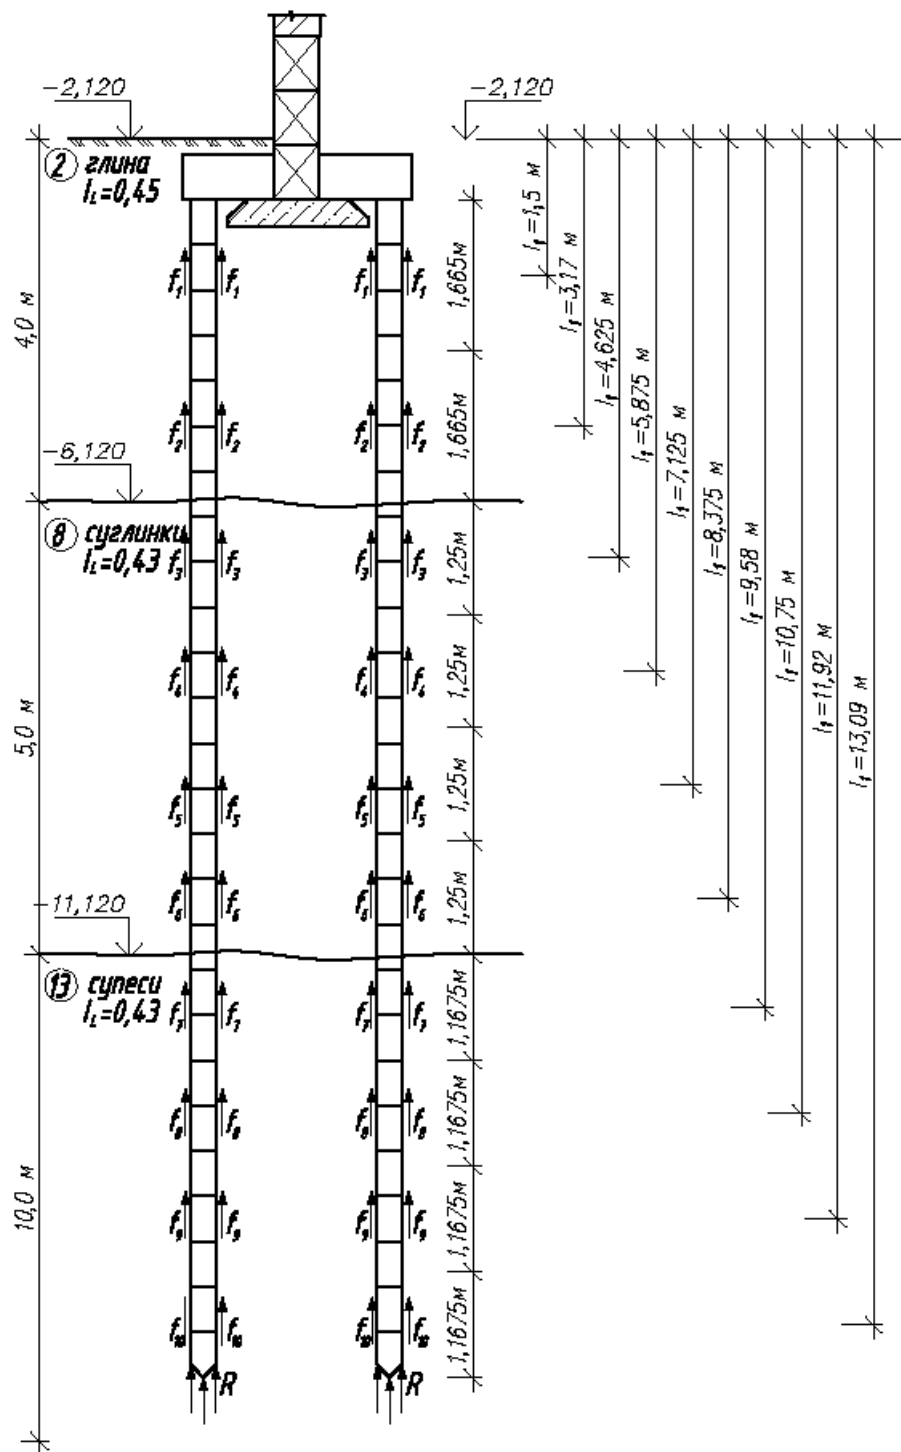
Разрез грунтовой толщи по свае
